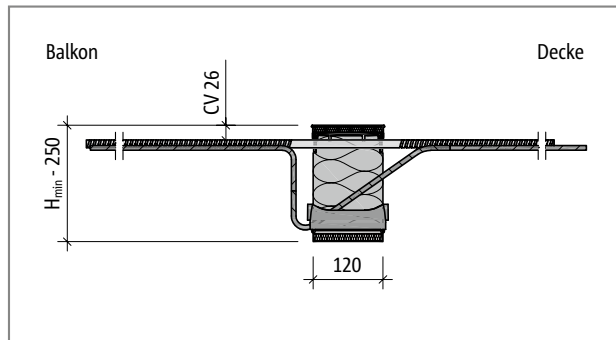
Schöck Isokorb® CXT Typ K bei Betondeckung CV26: Produktschnitt
